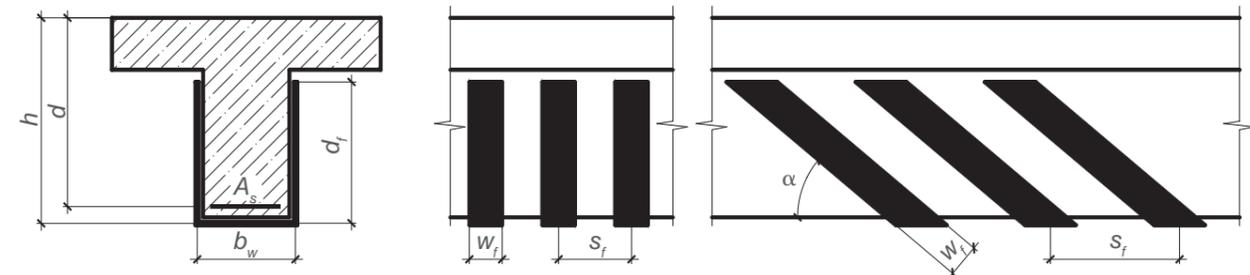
Размещение СВА FibArm хомутов для усиления наклонных сечений
